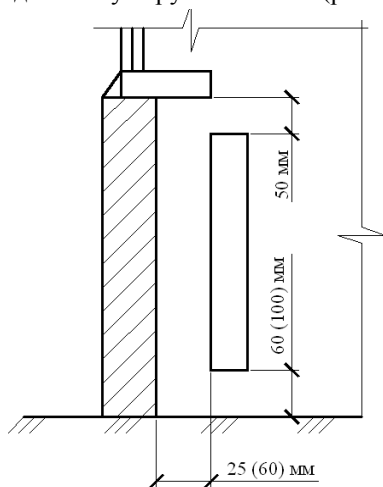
Схема расположения чугунного радиатора под окном у наружной стены
